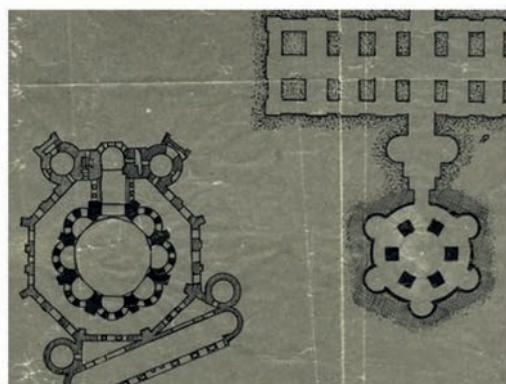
Comparazione della pianta della grotta Felici con la pianta di San Vitale di Ravenna – L.R. Pedretti 1953, fondo Pedretti Bibl. Gambalunghiana Rimini
